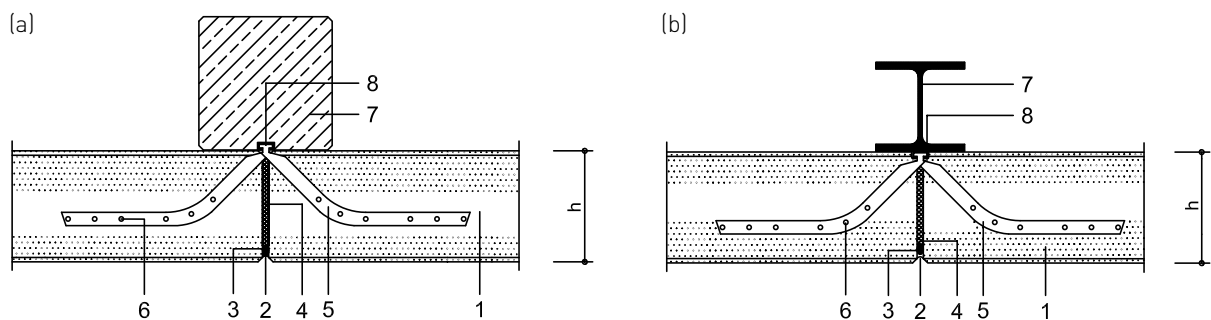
Szczelne połączenie w stropach/dachach wykonanych z elementów zbrojonych YTONG: (a) połączenie na sucho, (b) połączenie z wypełnieniem profilu zaprawą.
